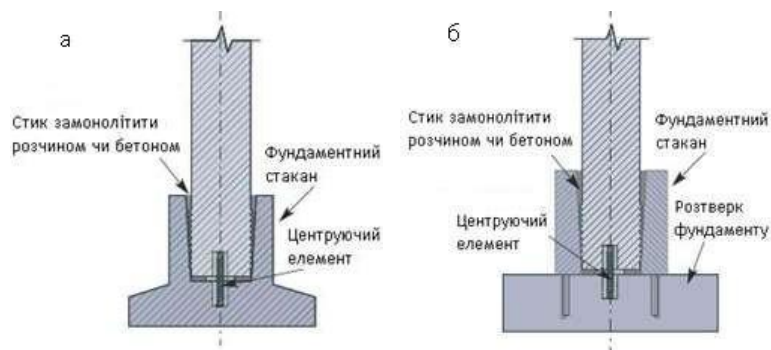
Кріплення залізобетонних колон з фундаментом: а – з стовчастим фундаментом; б – з пальовим фундаментом.
